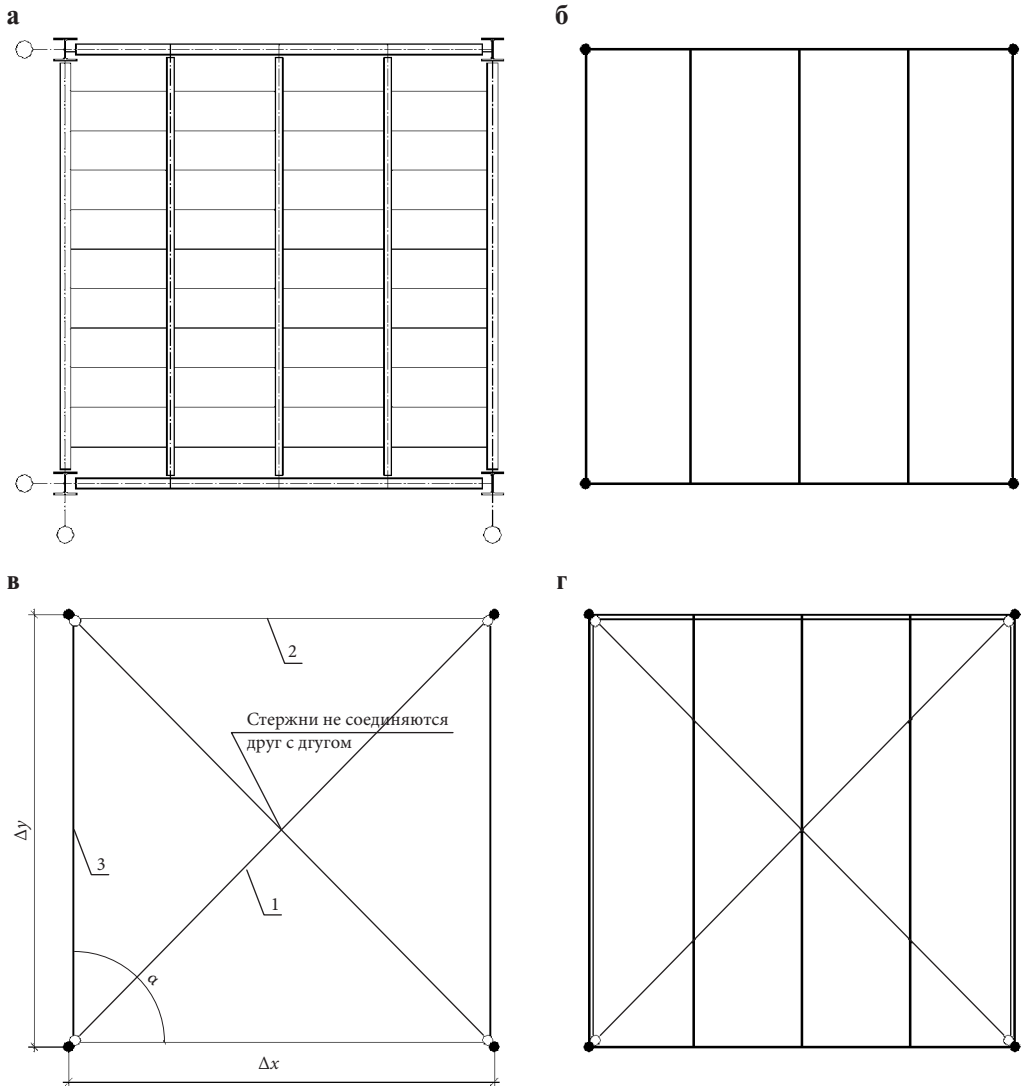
Расчетная схема перекрытия с заполнением легковесными вкладышами и мелкогазобетонными плитами: а) схема расположения элементов перекрытия; б) стержни, моделирующие главные и второстепенные балки; в) шарнирно-стержневая система, моделирующая жесткость заполнения в плоскости перекрытия; г) полная расчетная схема перекрытия
